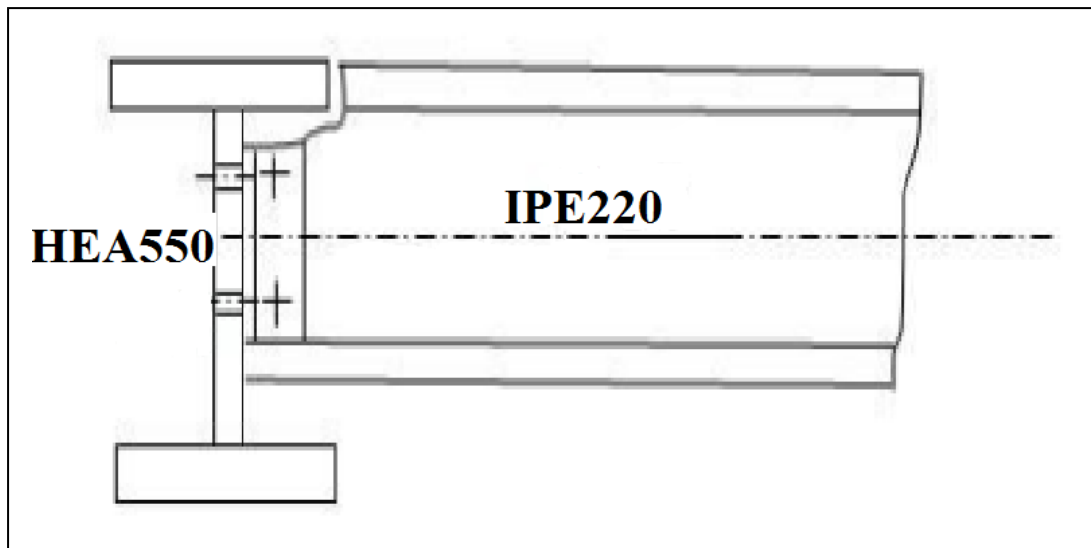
Schéma de l'assemblage poutre principal-solive (HEA 550-IPE 220).
